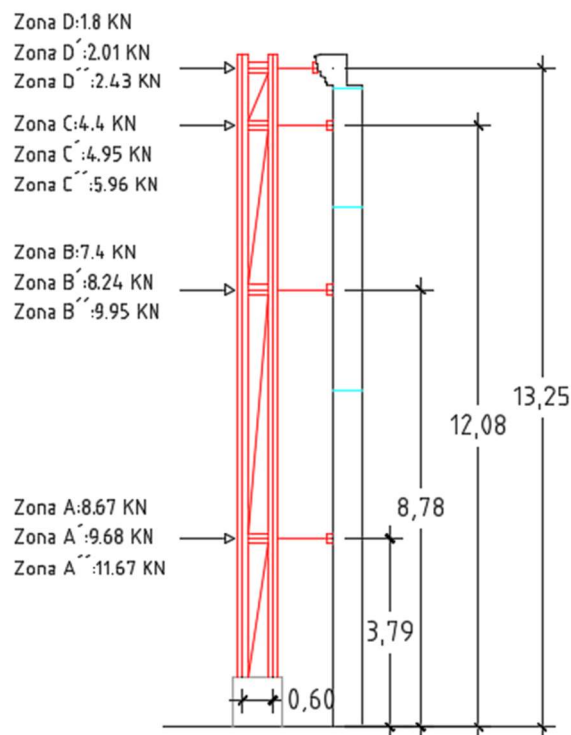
, Esquema de la estructura metálica con las fuerzas aplicadas
